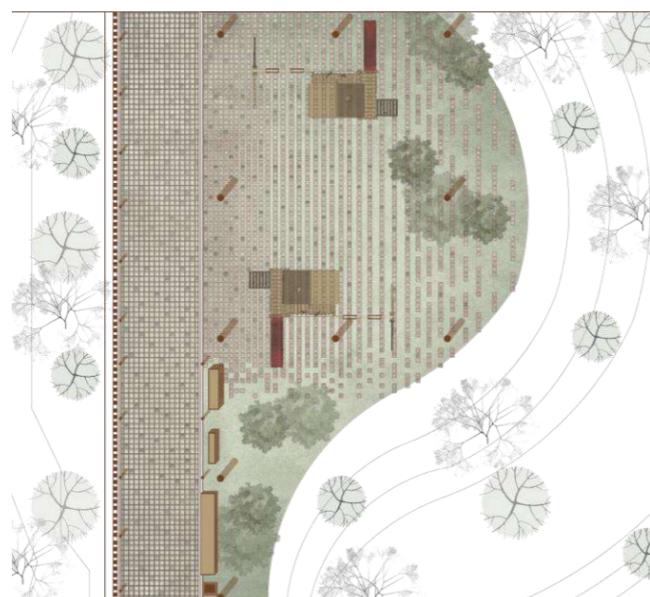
PLANTA 2 – SENDERO ECOLÓGICO
